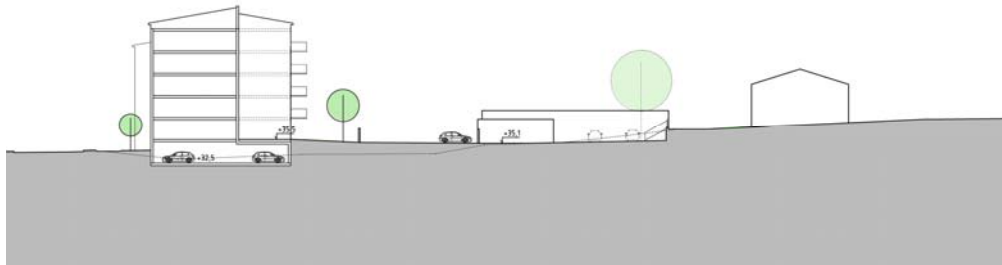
Illustrationen visar ett tvärsnitt genom föreslagen bebyggelse, parkering, livsmedelsbutik och radhus.
